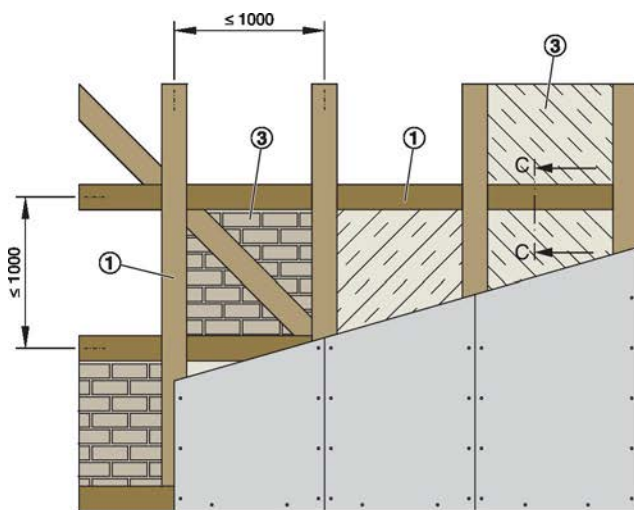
Leichtbauwand mit Holzfachwerk und beidseitiger Beplankung
